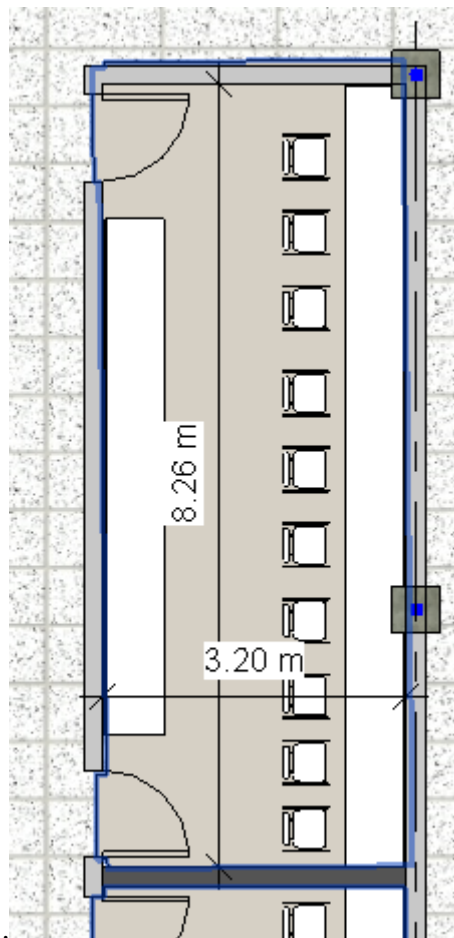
Vista en planta de un camarín grupal. Fuente: elaboración propia.
